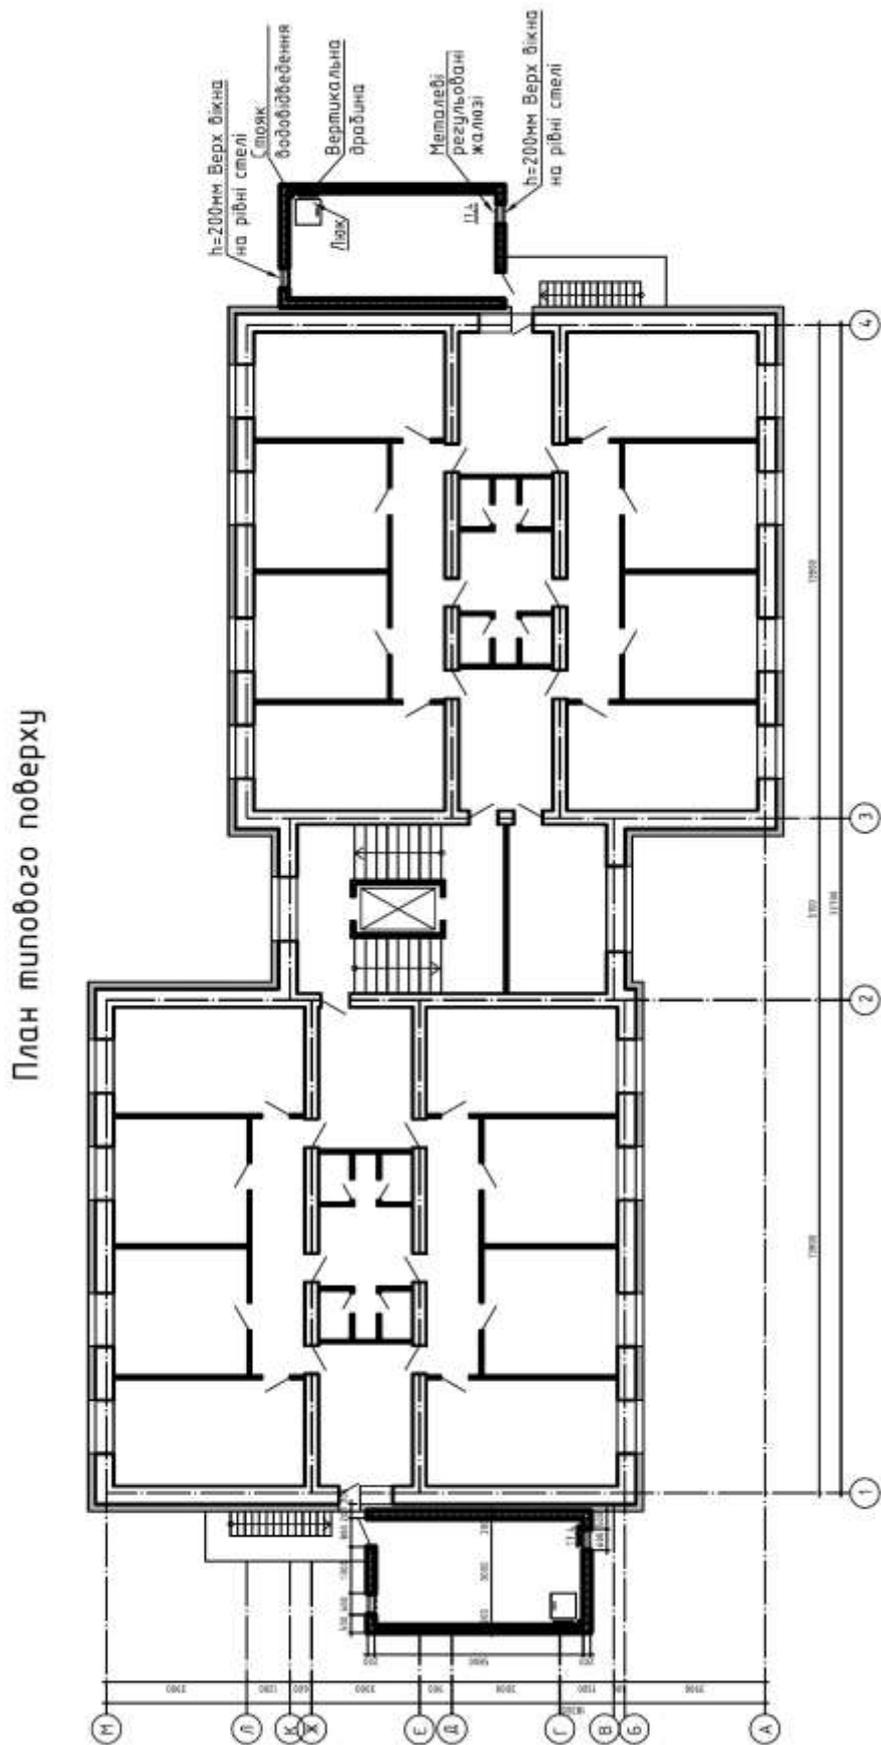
Схема плану типового поверху громадського будинку, проектна пропозиція
